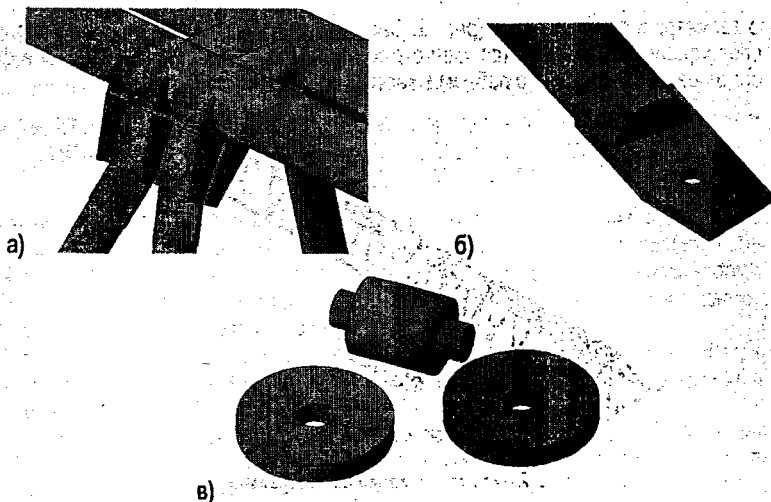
(а) Узел соединения раскосов и поясов фермы; (б) конструктивное решение балансирующего шарнира; (в) крепежный элемент
